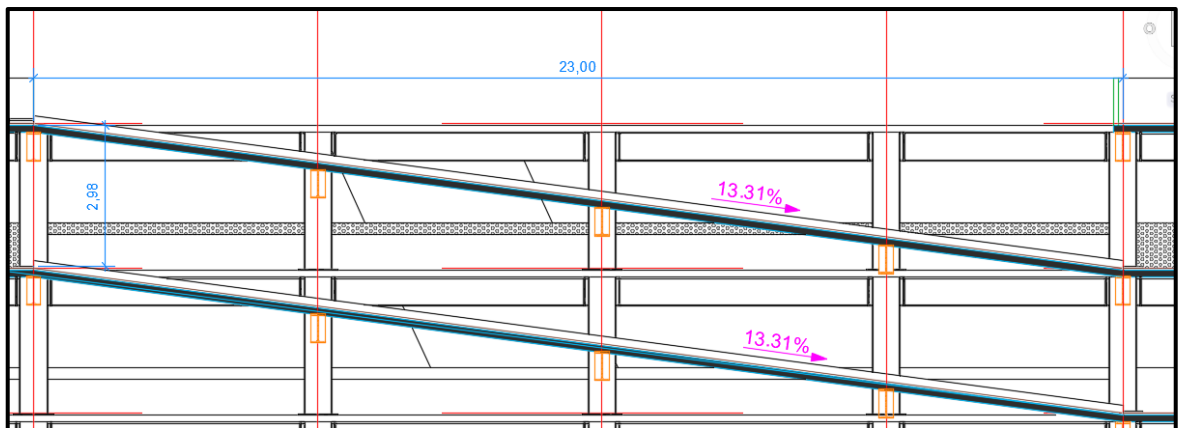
Coupe A-A d'une rampe tirer du plan d'architecture
